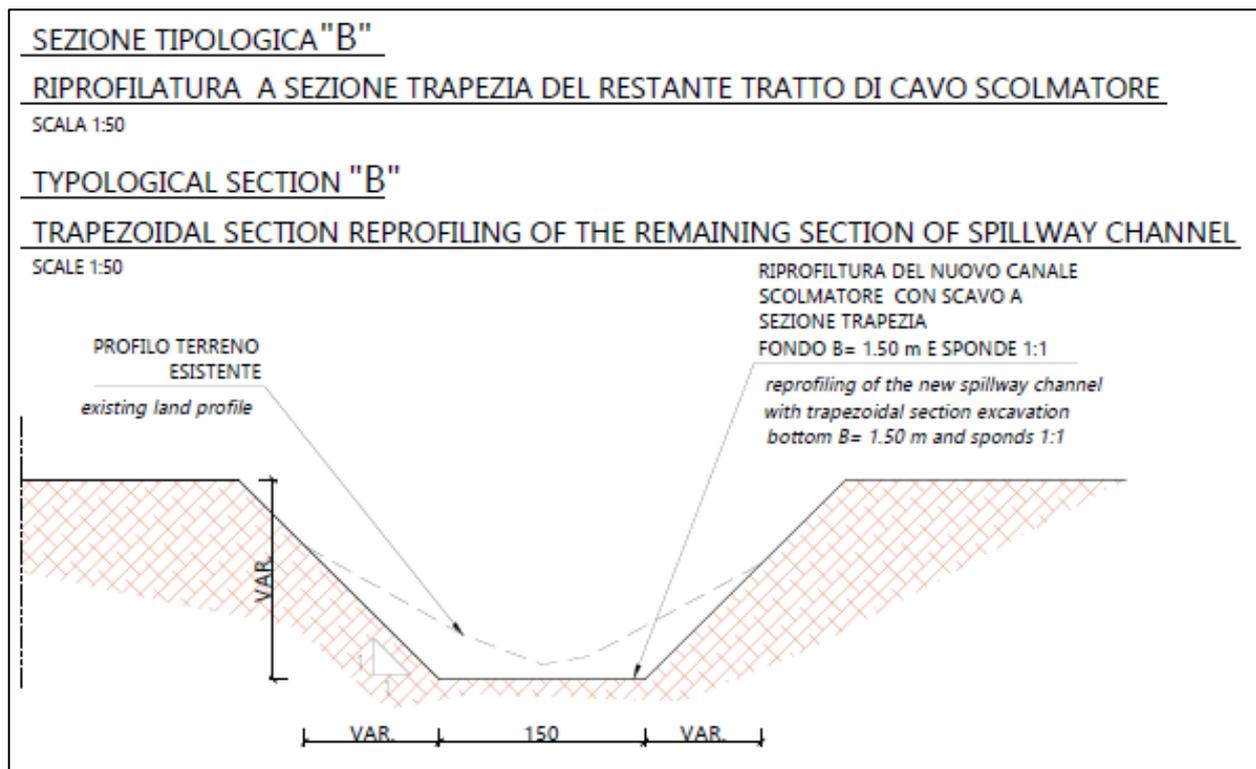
Sezione idraulica tipo del nuovo canale scolmatore – Estratto Tavola di progetto
